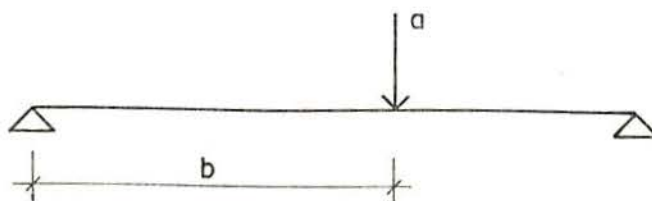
Carga concentrada em vigas, parâmetros:
